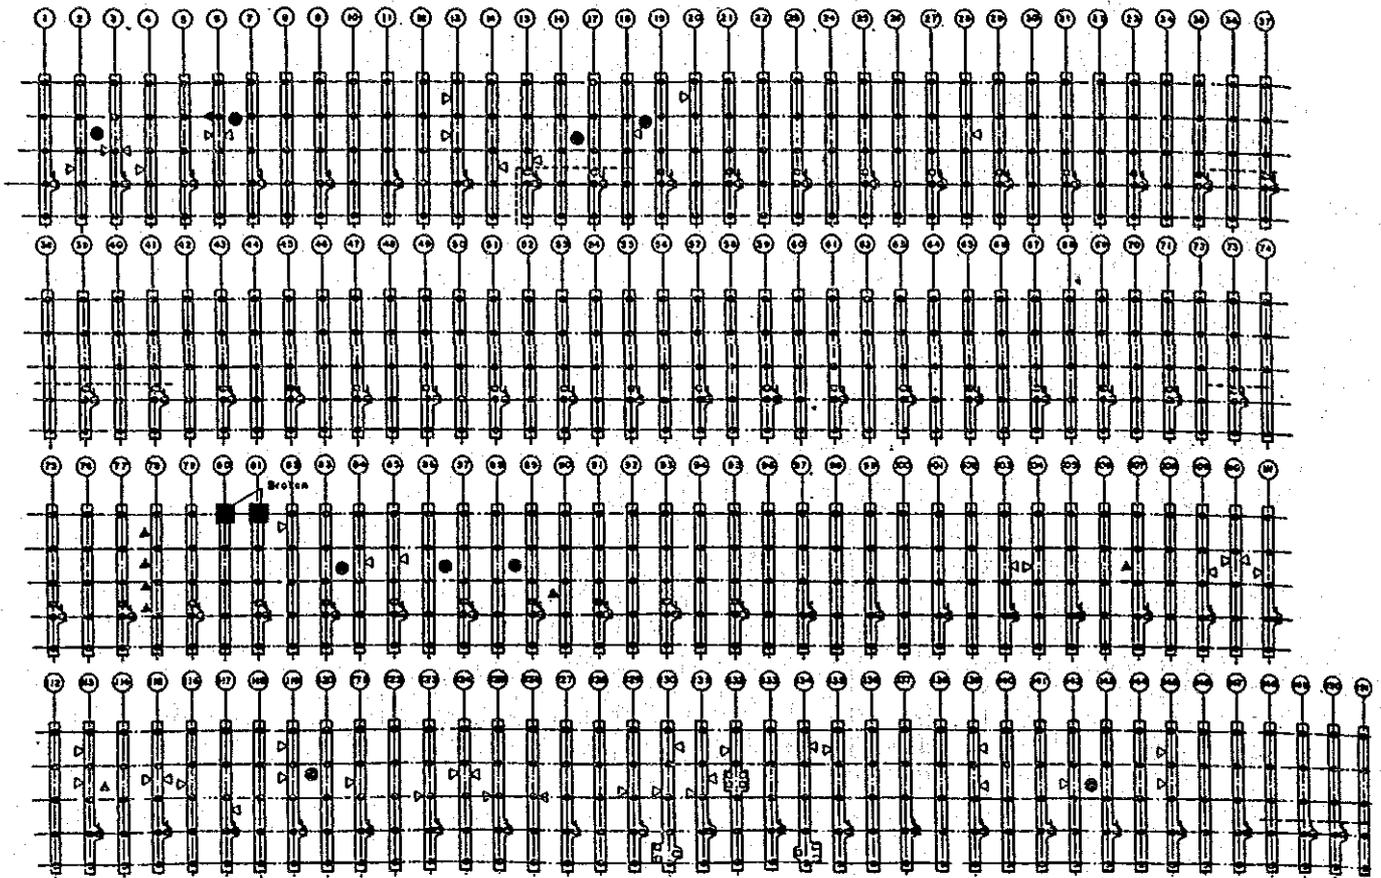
Ubicación de los Pruebas y Grietas
